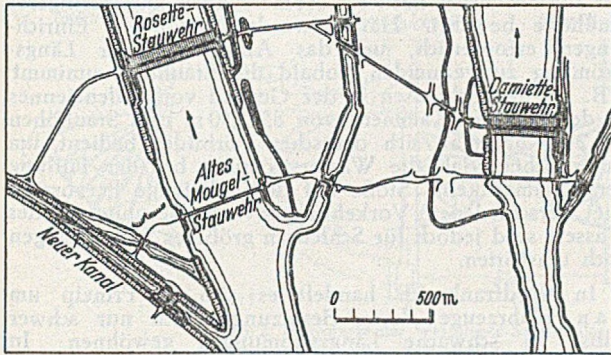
Lageplan der alten und des neuen Stauwehres.
